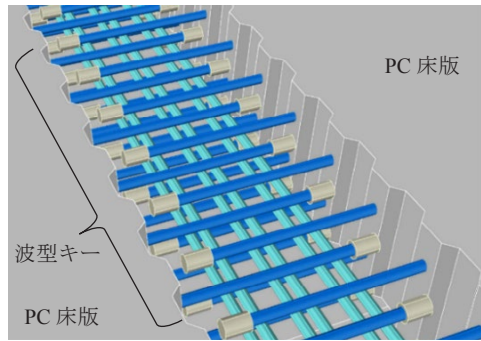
波型界面を有する PC 床版の接合部 (Joint between Precast Prestressed Concrete Deck Slabs with Corrugated Shape Interface)
